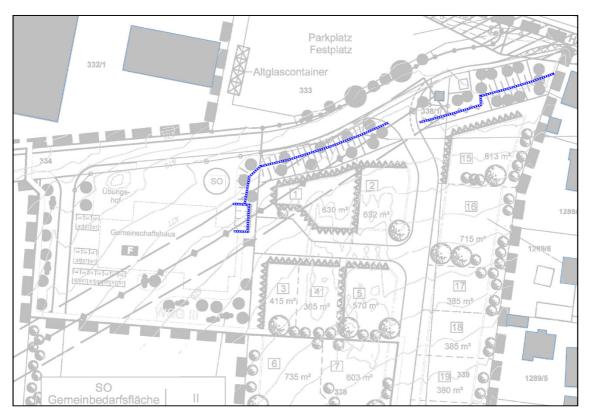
Lageplan mit Darstellung der aktiven Schallschutzmaßnahmen
